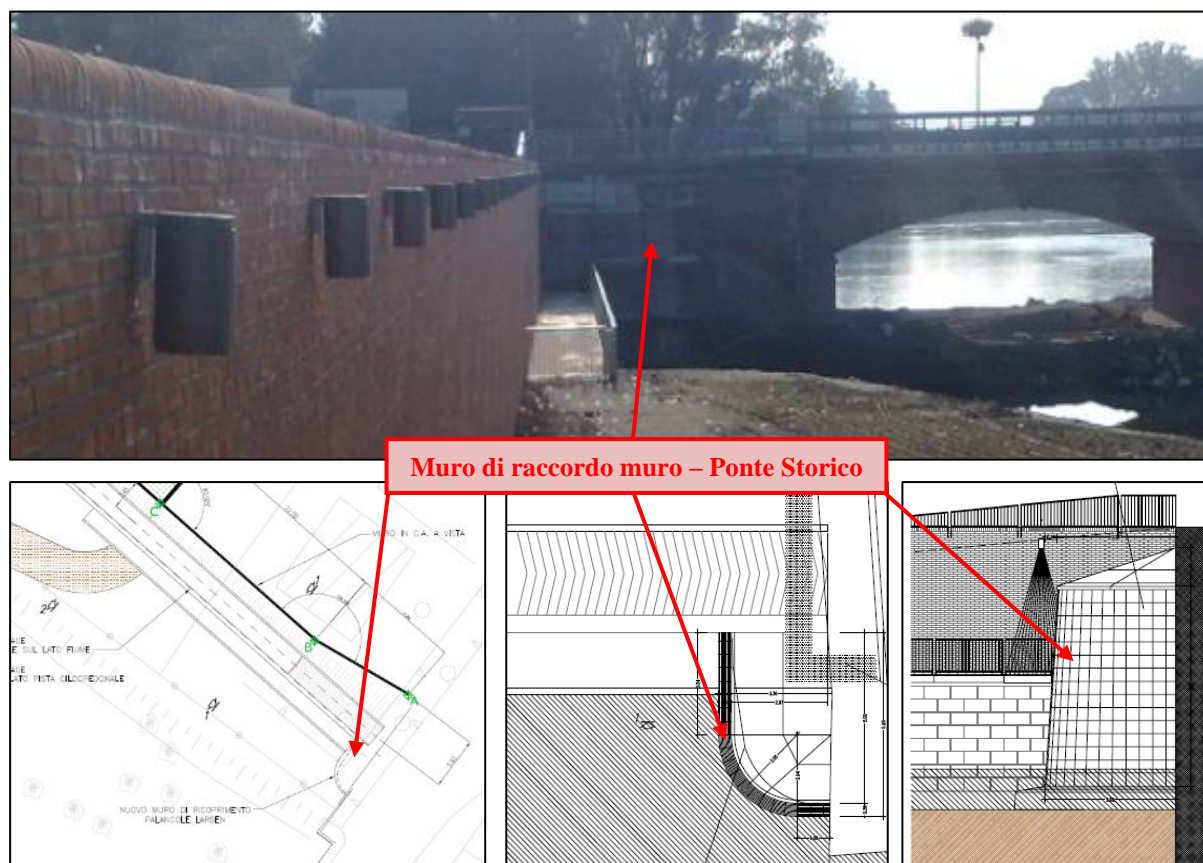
Situazione attuale muro di raccordo nuovo muro – Ponte Storico
